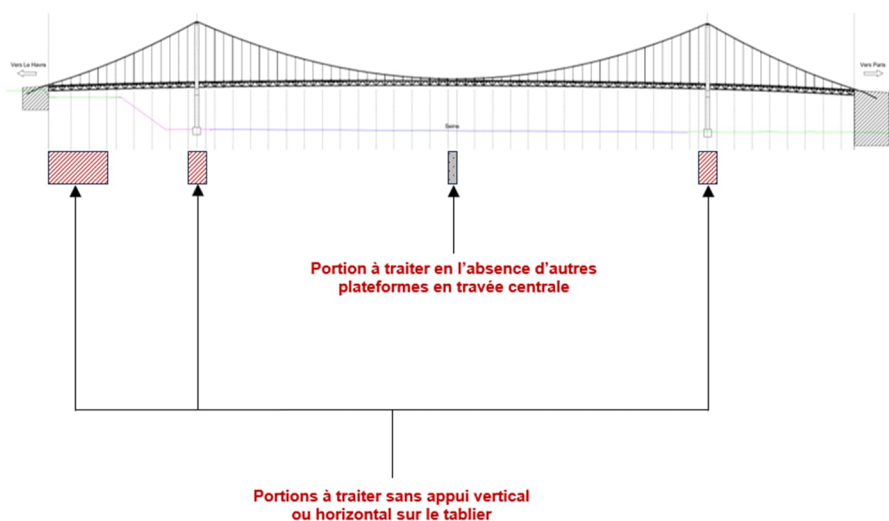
Coupe longitudinale sur l'ouvrage présentant les zones à traiter spécifiquement
